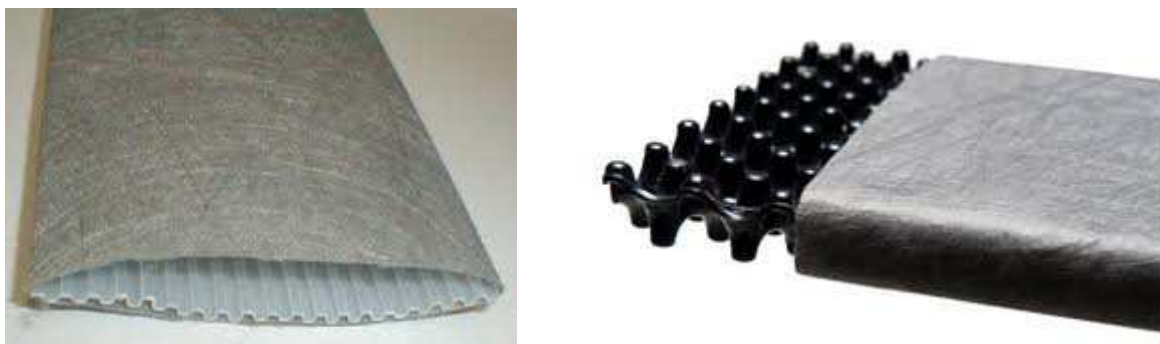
Diversas formas do núcleo central constituinte de um PVD (imagens retiradas em Outubro de 2014) de:
